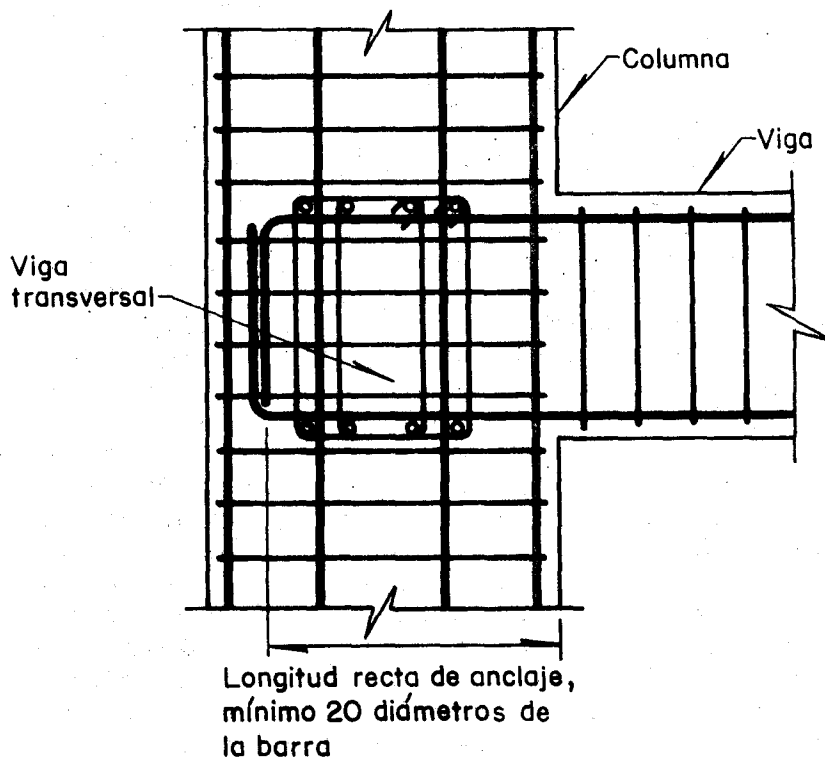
Ejemplo de unión viga-columna extrema según NTC del RDF87
